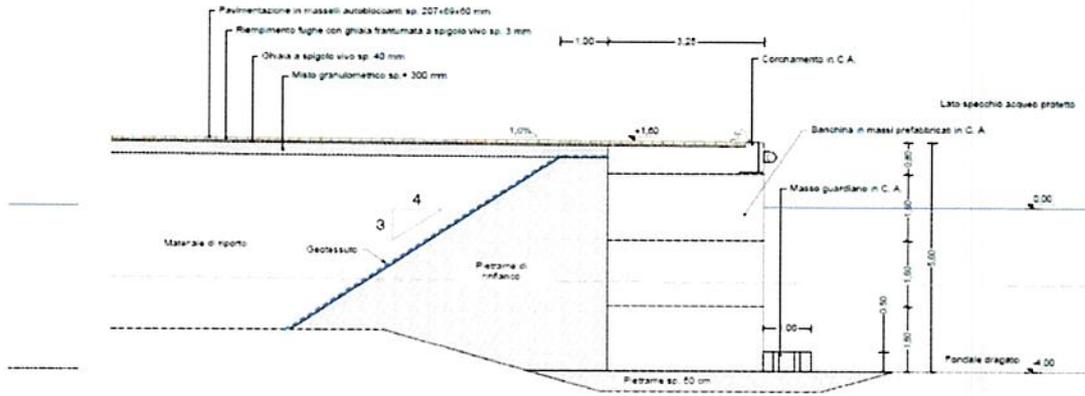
sezione Ovest tipo c5-c5 (tav. EG\_OMI 1\_3)
